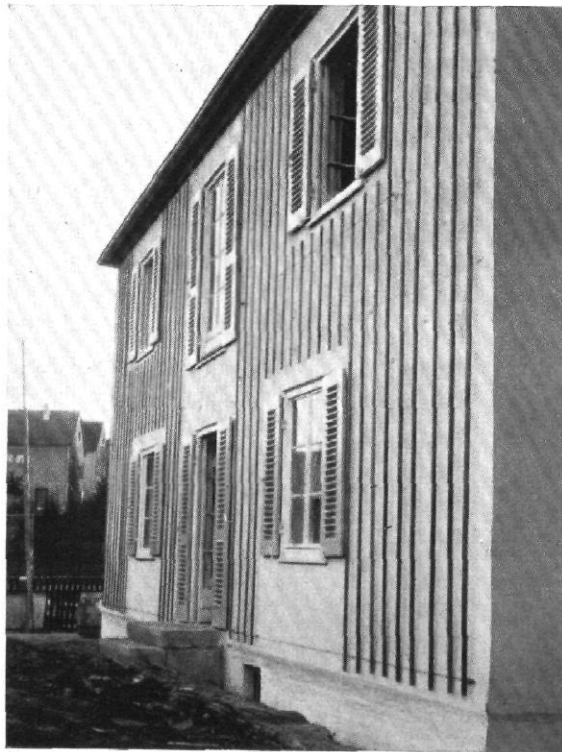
| Fabriziertes Fachwerkhaus, Haustyp F | Abwandlung durch Hangstellung und Abwandlungsmöglichkeiten der Südfront | Architekt: P. Schmittbener
